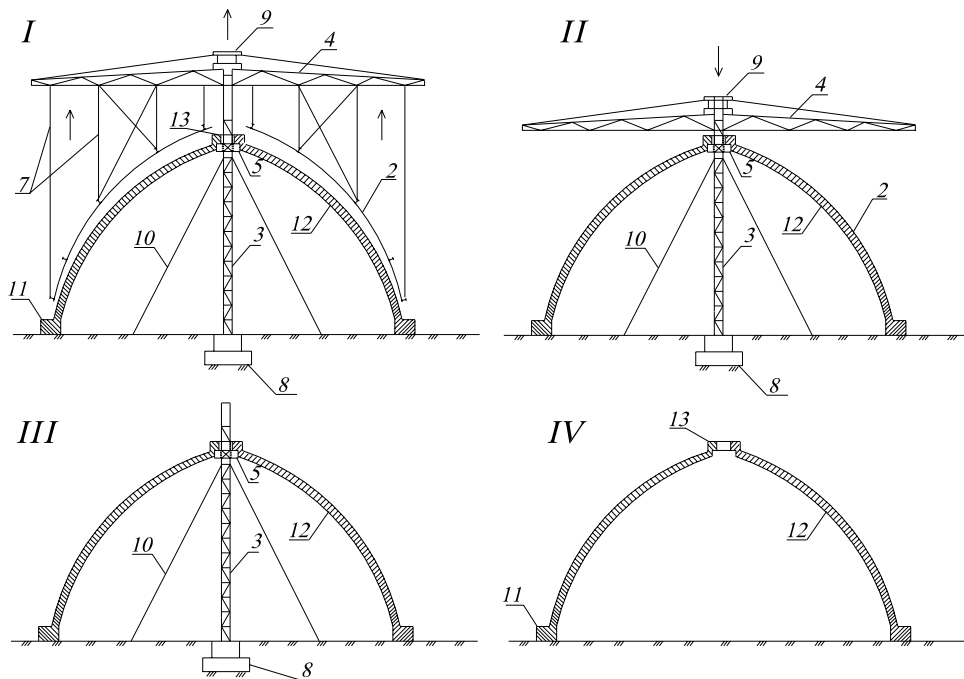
Последовательность демонтажа опалубки купола I–V: 2 – опалубка купола; 3 – временная опора; 4 – консольная стрела; 5 – неподвижное кольцо; 7 – связи; 8 – фундамент временной опоры; 9 – гидродомкрат; 10 – растяжки; 11 – нижнее опорное кольцо; 12 – оболочка купола; 13 – верхнее опорное кольцо; 14 – ограничительные бортики.
